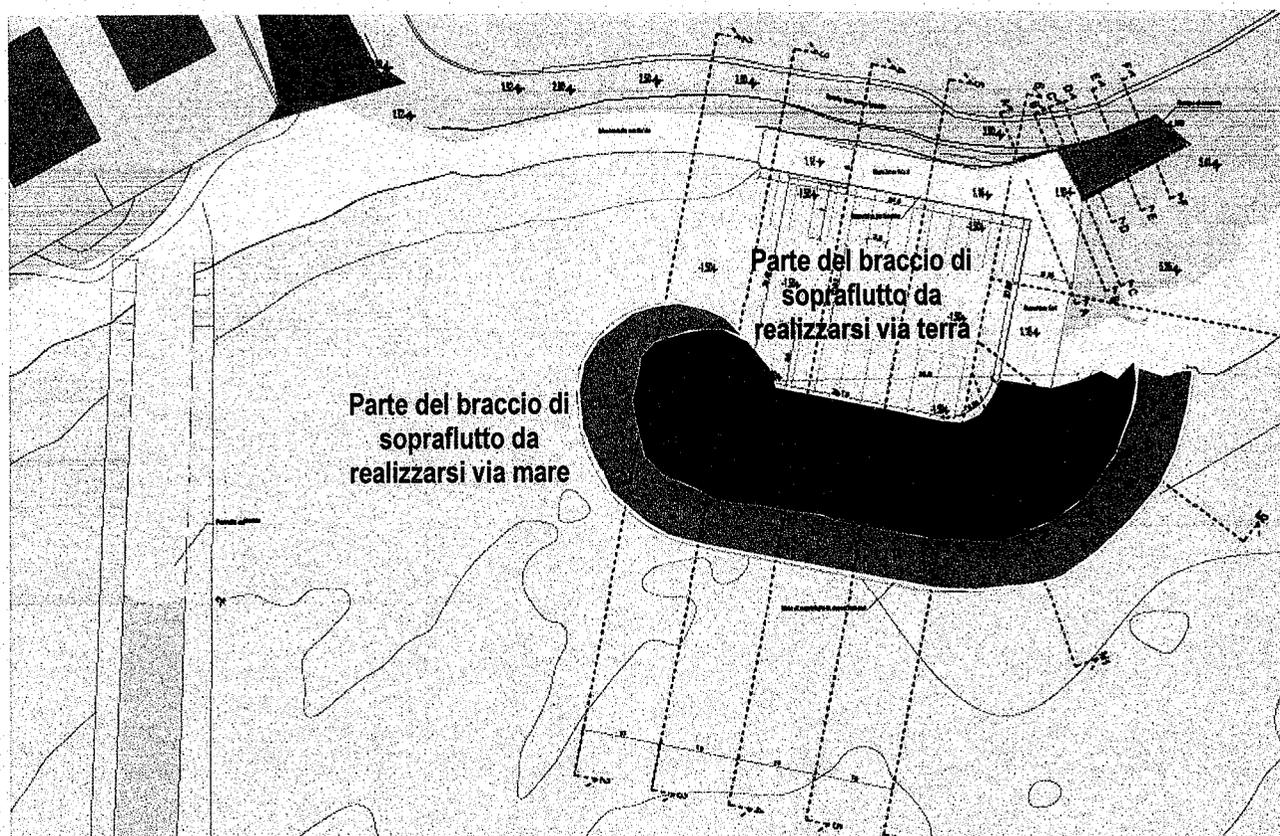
Planimetria con suddivisione delle opere di progetto (braccio di sopraflutto) in funzione delle modalità realizzative
